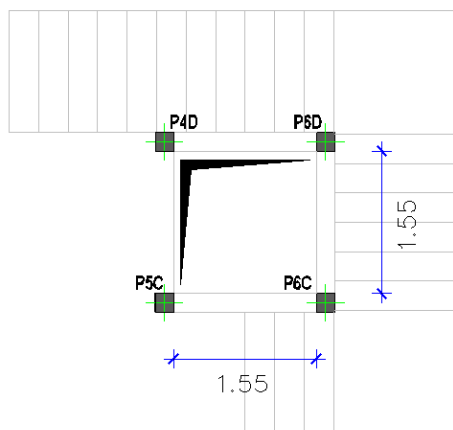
Alteração ao posicionamento dos pilares da caixa de escada
